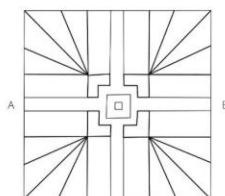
Projekt planszy – zadanie etapu III. Projekt autorstwa A. Pietrzak pod kierunkiem B. Linowieckiej
